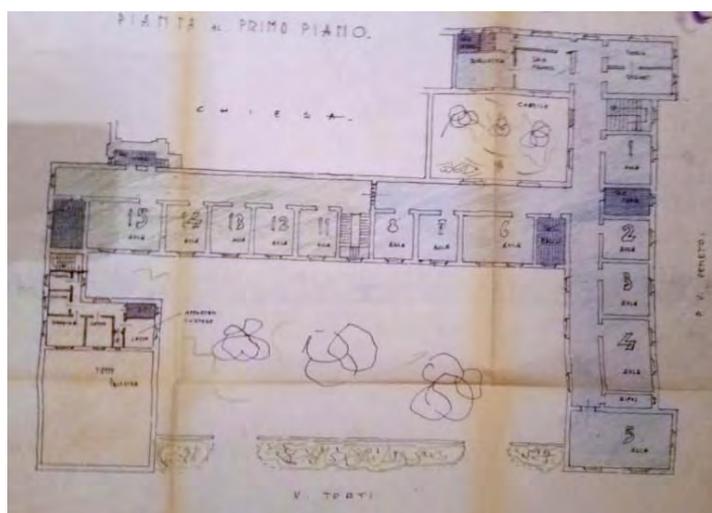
Disposizione finale degli spazi nel progetto dell'Ing. Mario Barbieri (piano primo)
